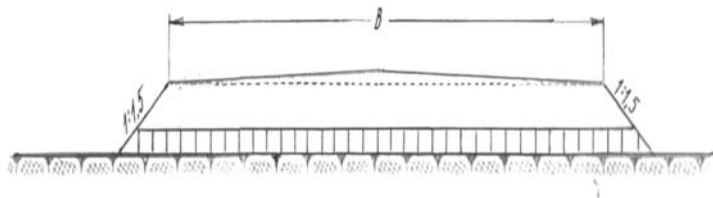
Поперечный профиль насыпи, возводимой из местных грунтов с основанием, армированным геоячейками «ПРУДОН-494»
